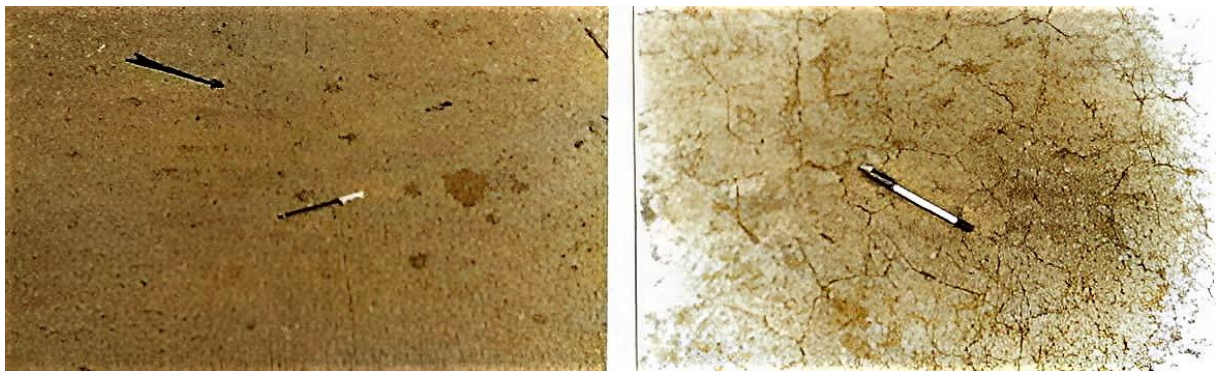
Fisuras plásticas dispuestas de manera aislada y en malla.¹²⁰
